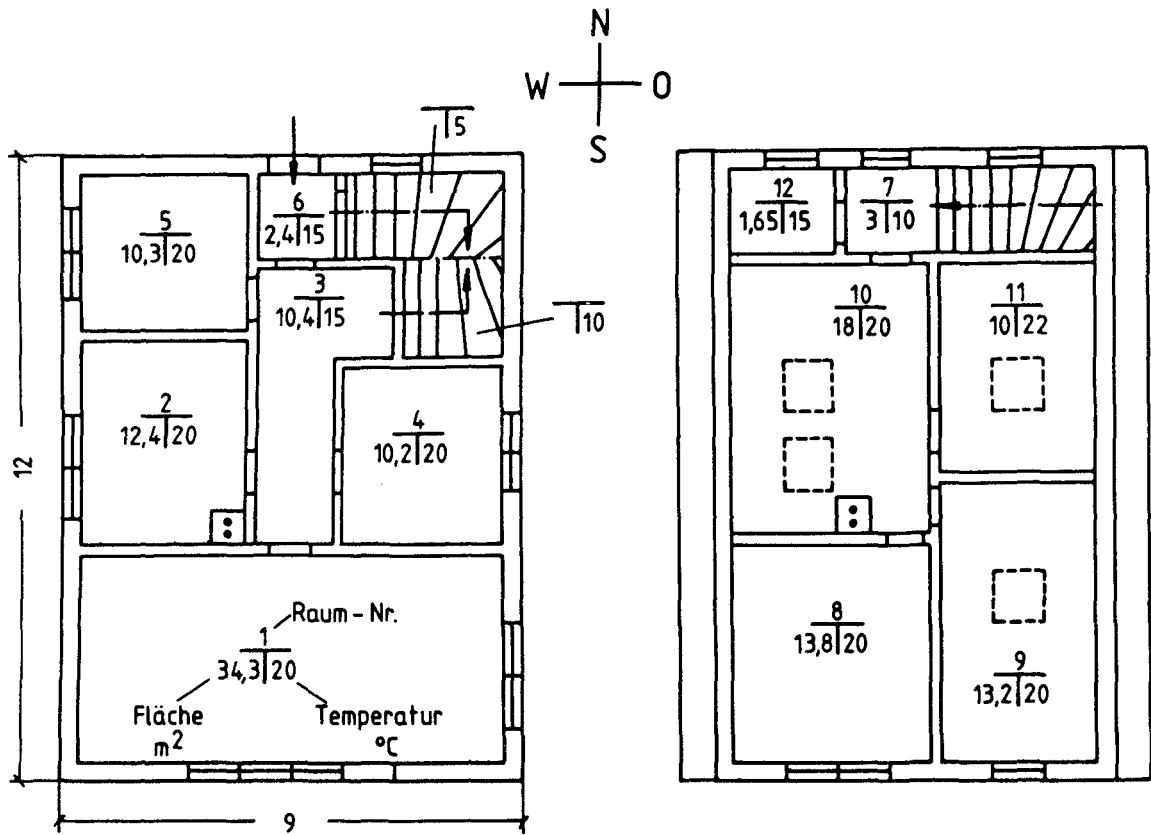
Grundriß (M 1:100) des Einfamilien-Satteldachhauses (45° Dachneigung)
